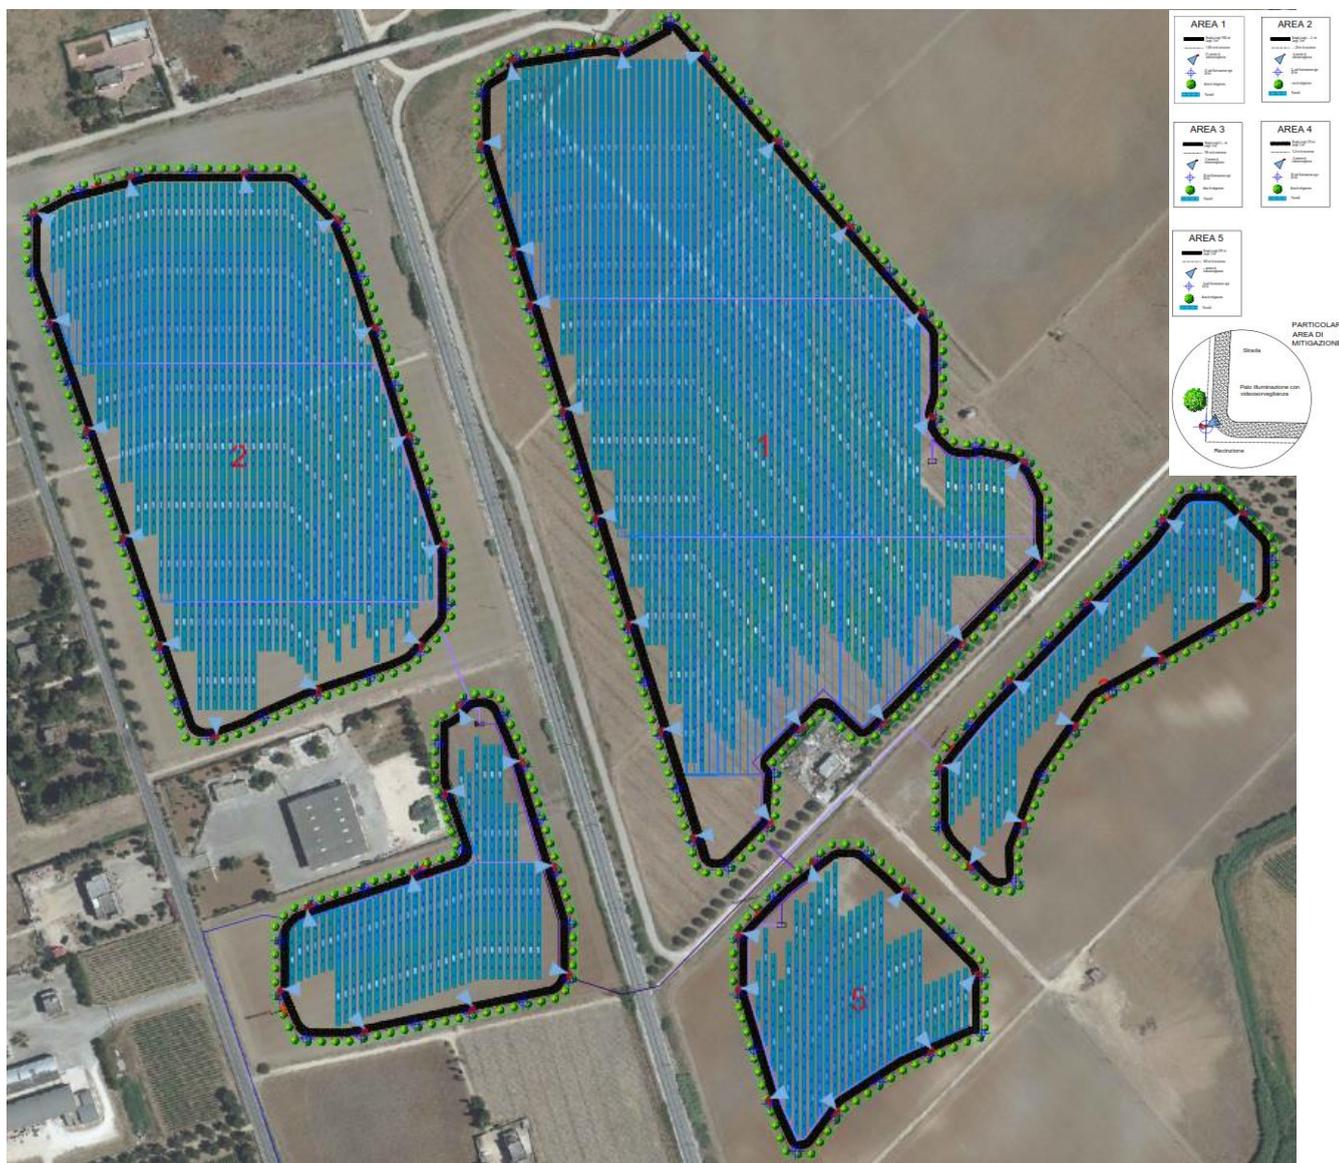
Planimetria dell'impianto con fascia alberata perimetrale, recinzioni e impianto videosorveglianza.
